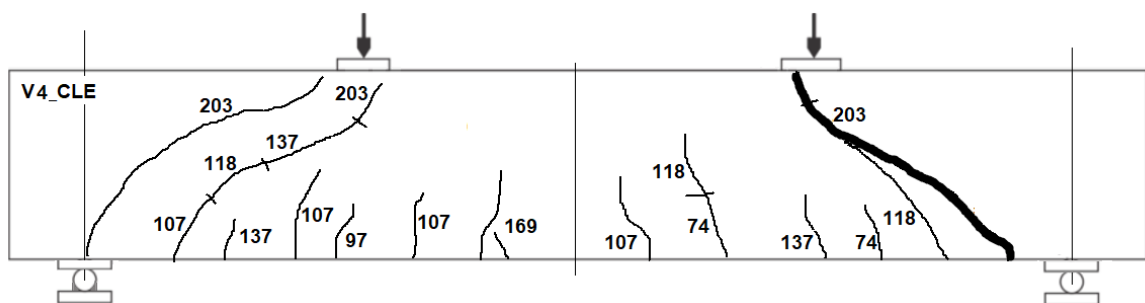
Esquema de fissuração da Viga 4_CLE.
